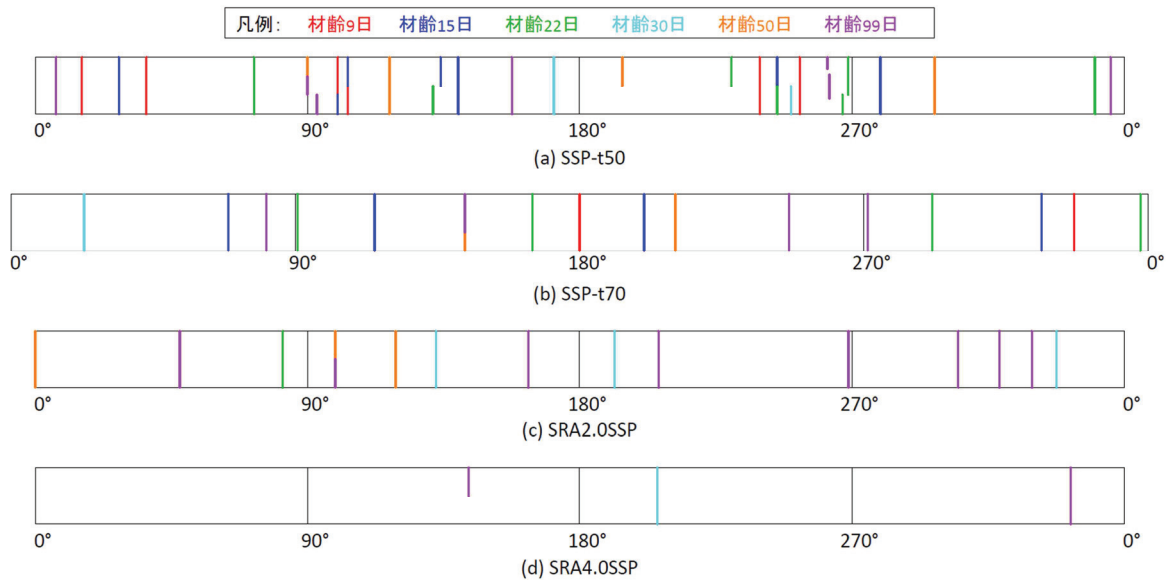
ひび割れ展開図 (シリーズ 3)
